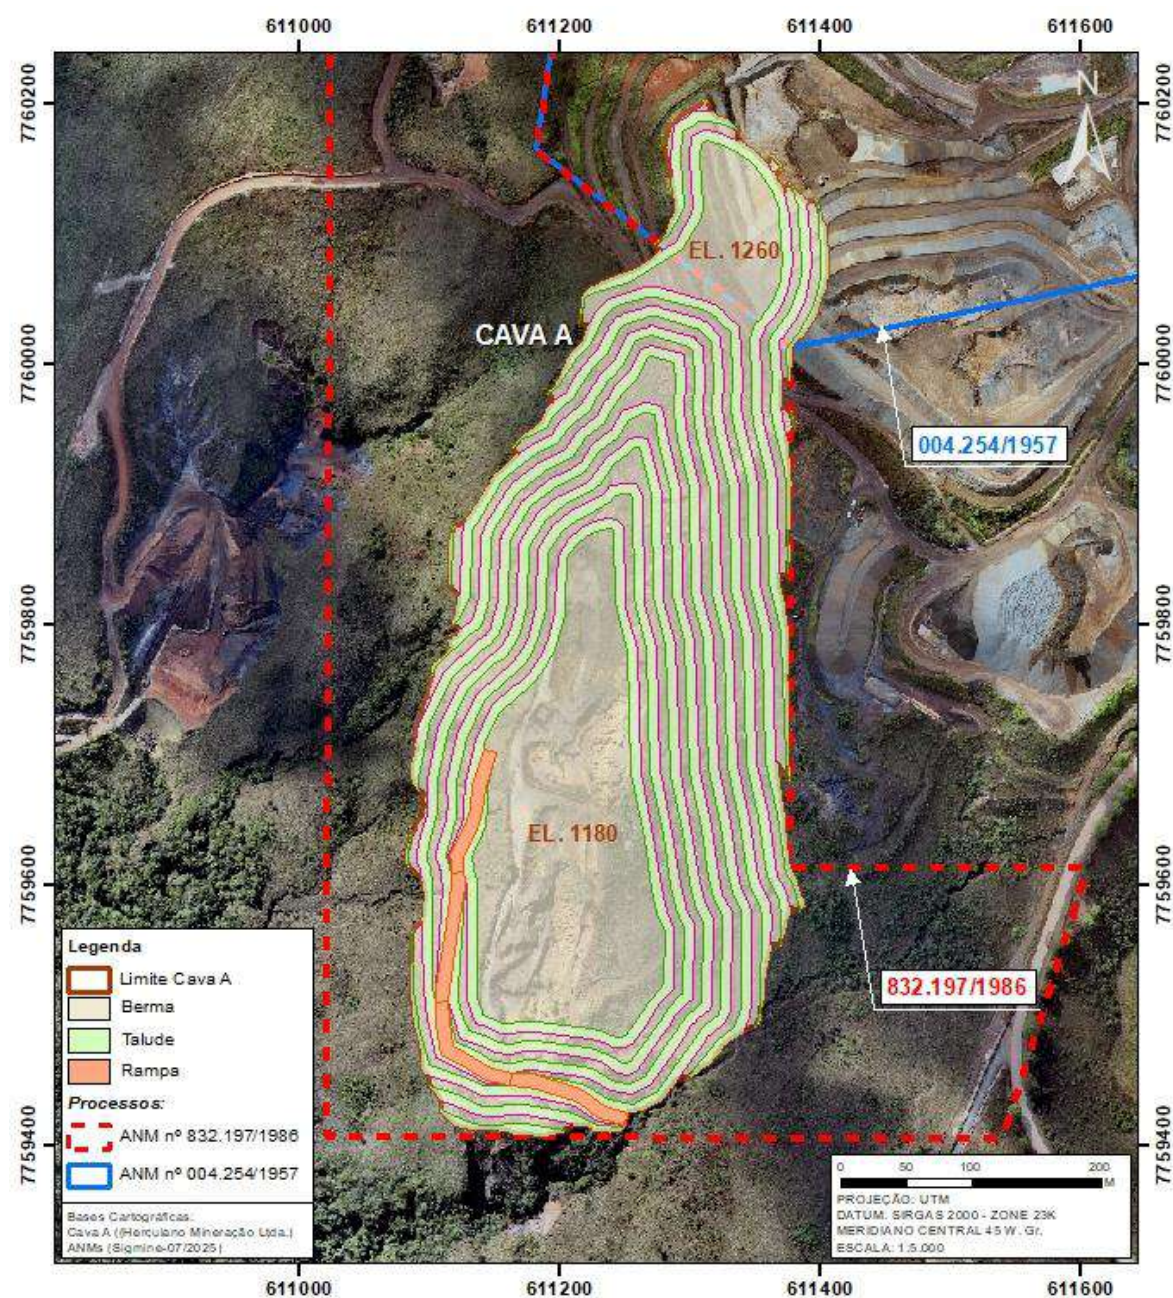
Cava A da Mina do Tanque Seco em sua configuração planejada.
